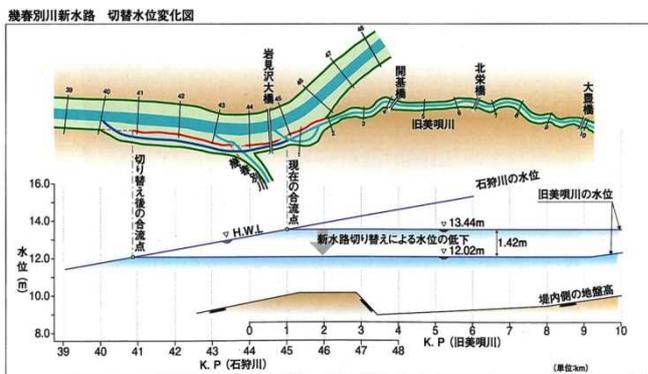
幾春別川新水路平面図、縦断面図
